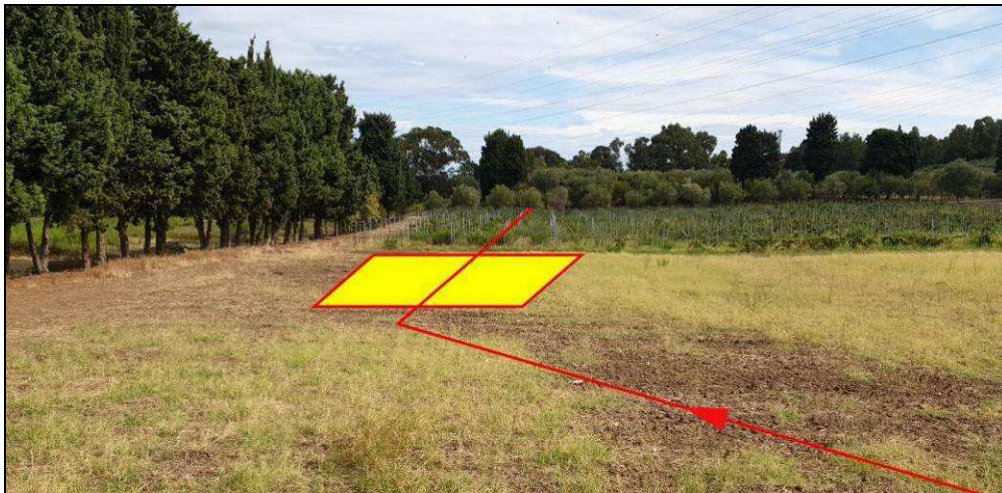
/N – Panoramica area dell'impianto PIDS km 3+267 in progetto.
